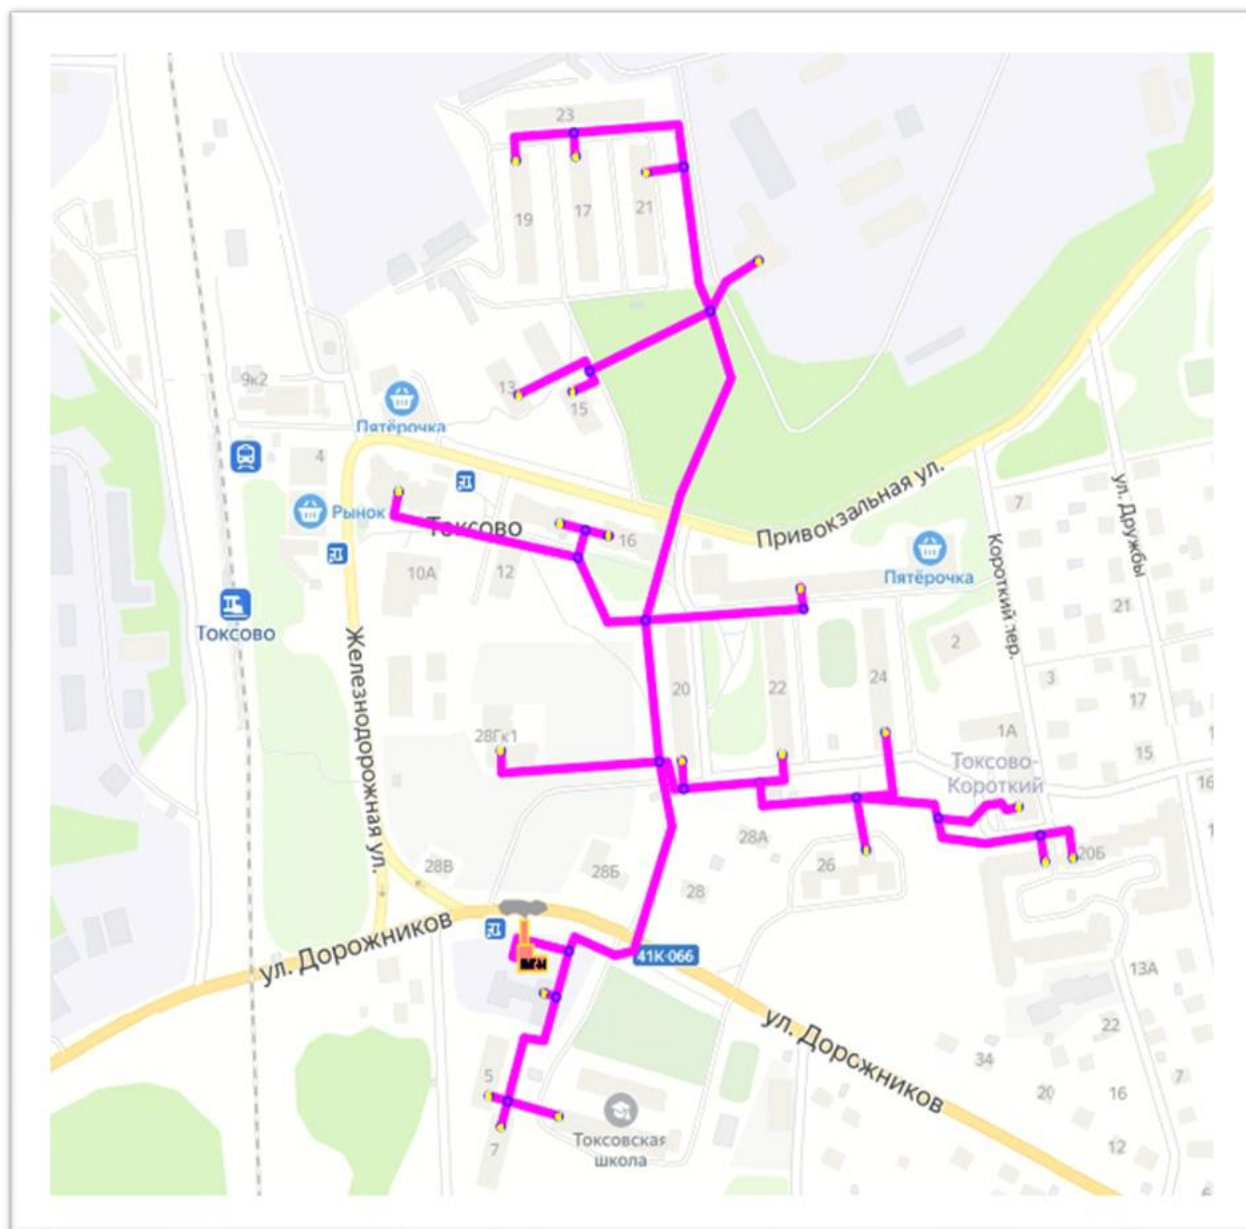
Схема тепловых сетей котельной БМК-8.4
